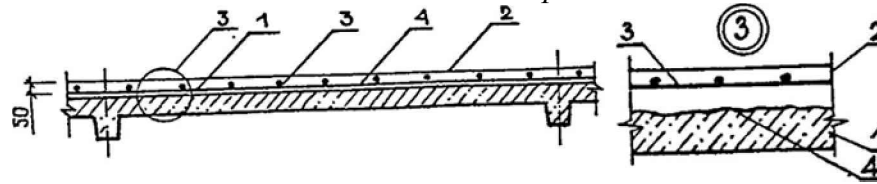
Підсилення плити перекриття нарощуванням зверху з додаванням поверхні шорсткості: 1 – плита перекриття, що підсилюється; 2 – монолітний шар бетону; 3 – арматурна сітка; 4 – поверхня зчеплення монолітного бетону з плитою (очищення, насичка, промивка водою)
